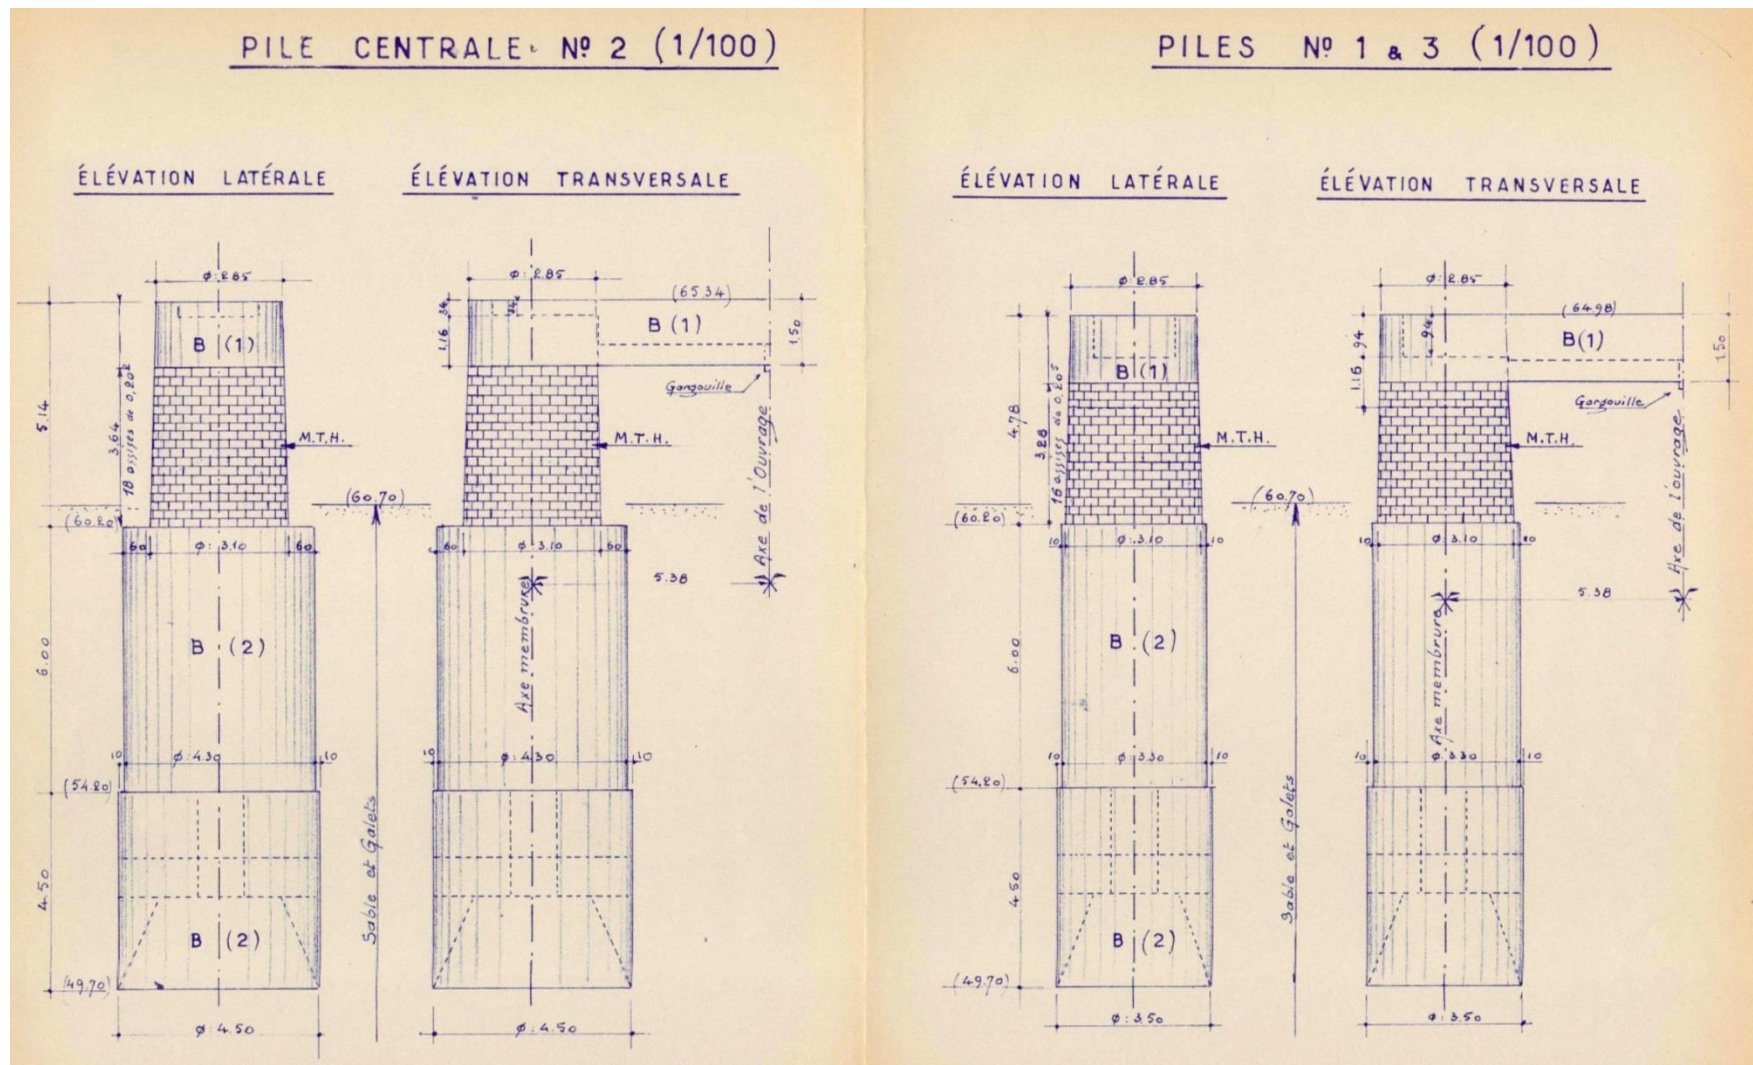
Plans des piles du pont de la Manda (source : /30/)
